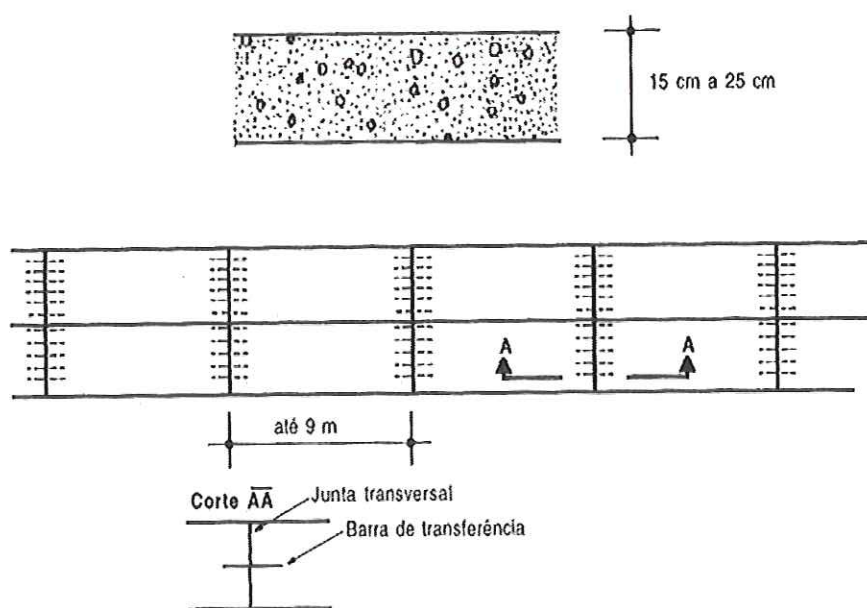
Pavimento de concreto simples c/ barras de transferência
